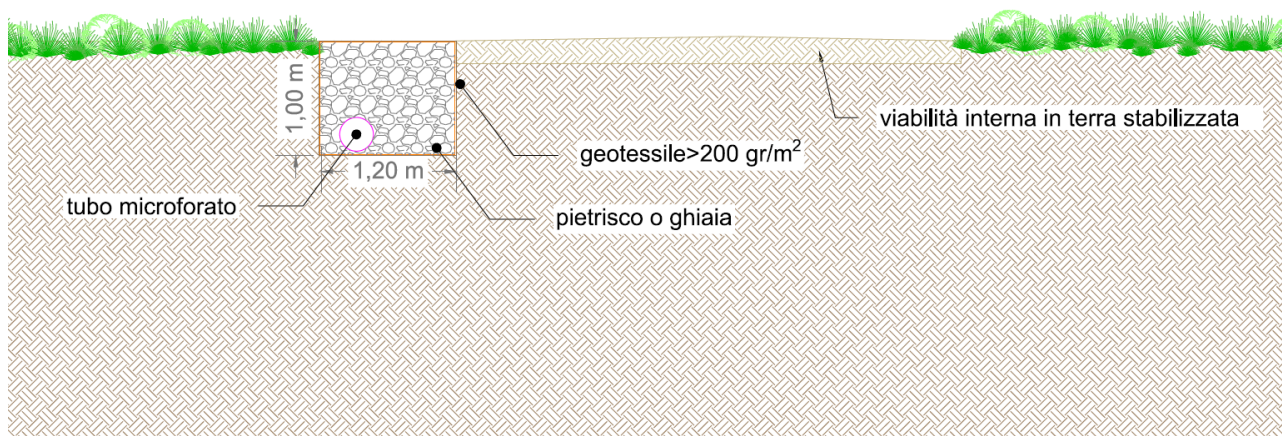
Particolare costruttivo in sezione della trincea drenante
